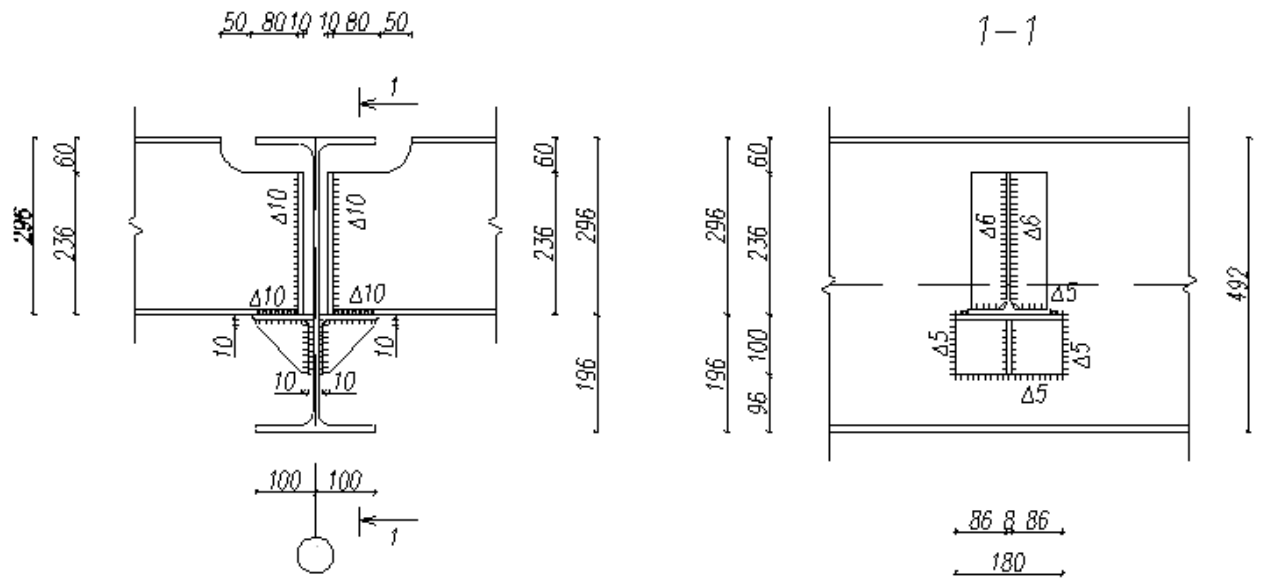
Схема кріплення прогонів 30Б1 до ригелів.
